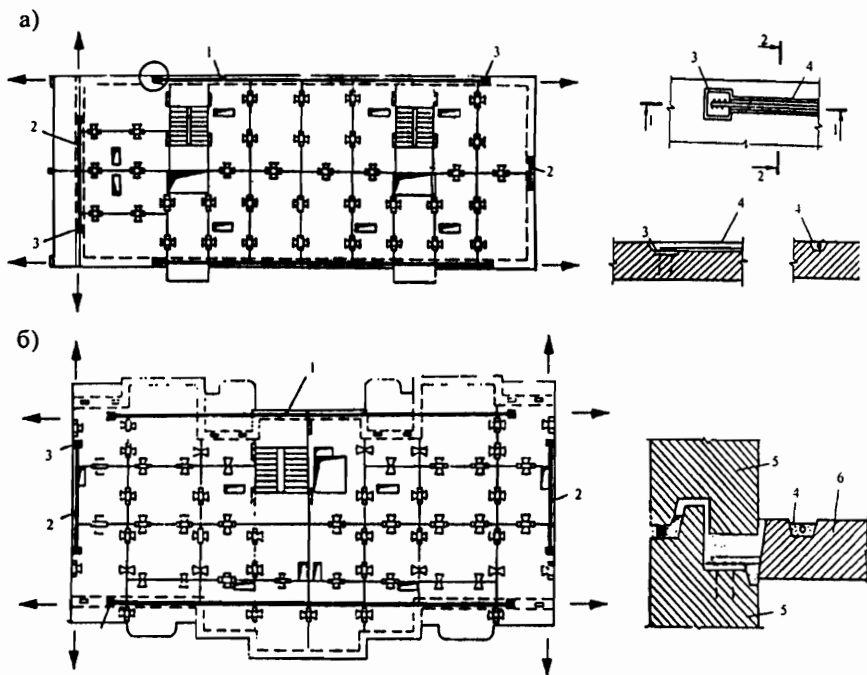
Расположение горизонтально напрягаемой арматуры в зданиях прямоугольного (а) и сложного (б) очертания: 1 – продольная горизонтальная напрягаемая арматура; 2 – то же, поперечная; 3 – закладная деталь; 4 – борозда; 5 – наружная стеновая панель; 6 – плита перекрытия
